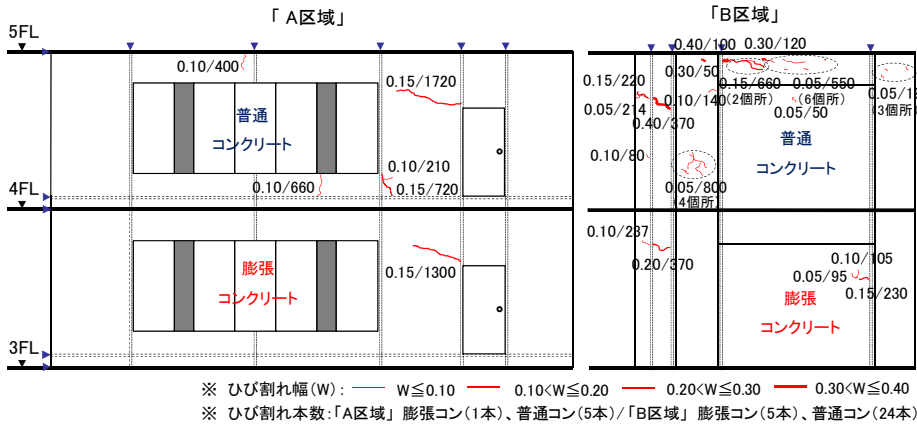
ひび割れ調査結果 (ひび割れ長さ (mm) / ひび割れ幅 (mm))
